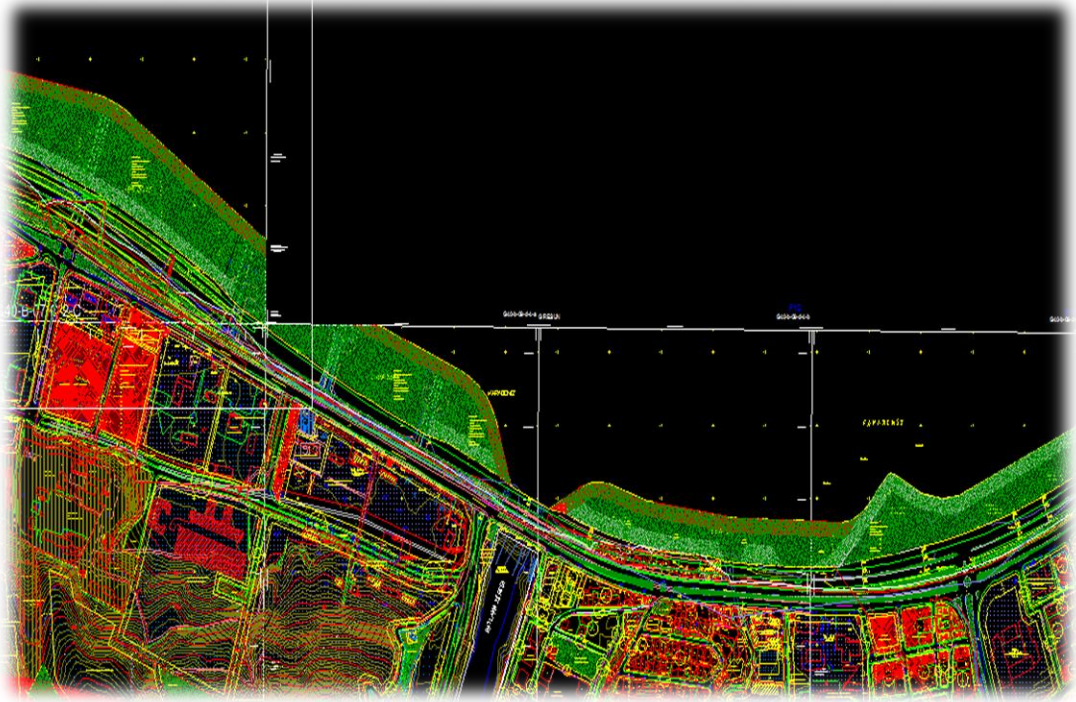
Hizmet Kurumlarının Bulunduğu Alan Planı
